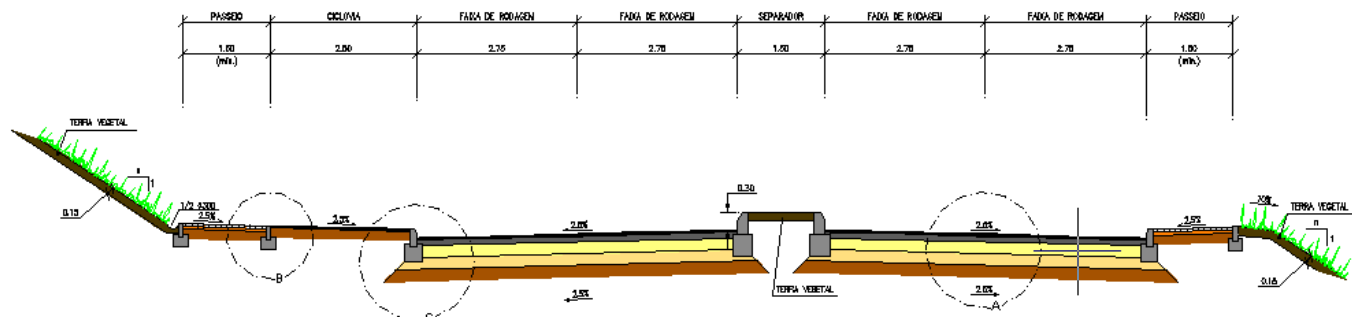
Perfil Transversal Tipo do troço entre a Rotunda ER.10 e a Rotunda A.M.2
